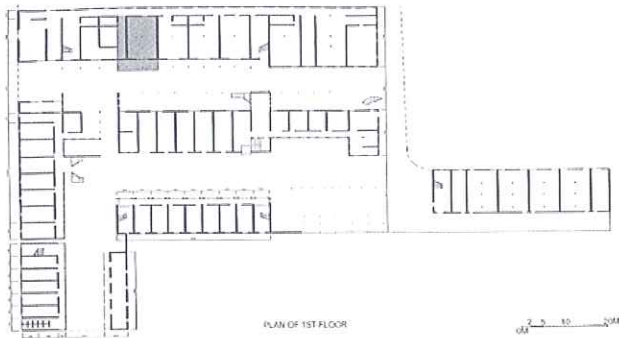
A棟1階平面図(塗りつぶした部分が出火場所)
